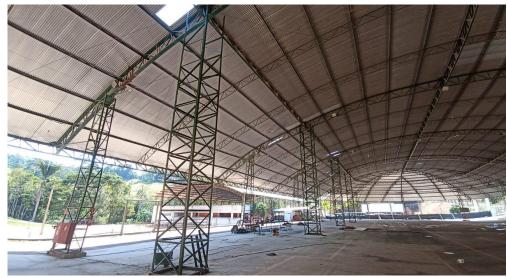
Detalhe para das estruturas metálica (torres) fixas no topo e na base e devidamente pintadas
